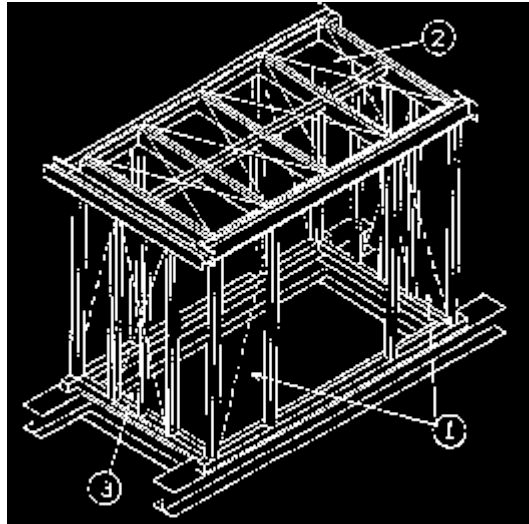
Vue perspective de l'essai PDT du mur P1 (ouverture).* Perspective view of the PDT set-up of wall P1 (opening)
